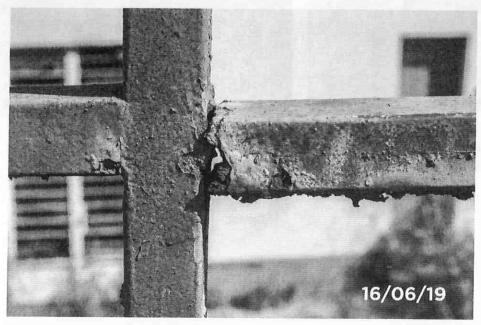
Detalhe pontos de corrosão na estrutura metálica no guarda corpo.
